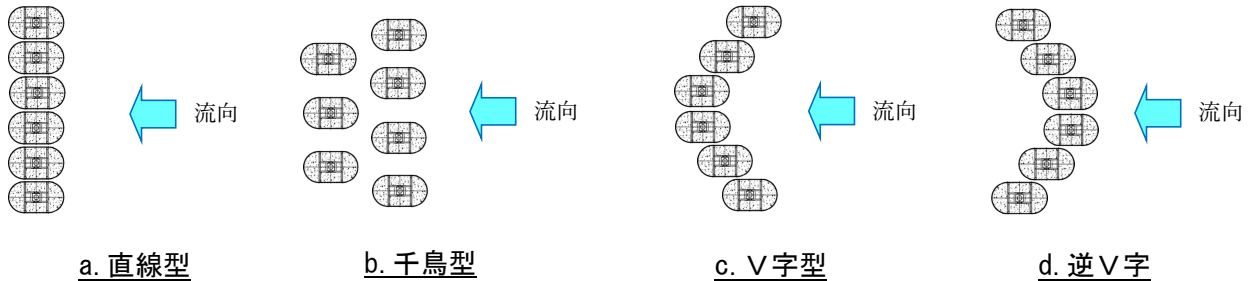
独立基礎型流木捕捉工の平面配置
